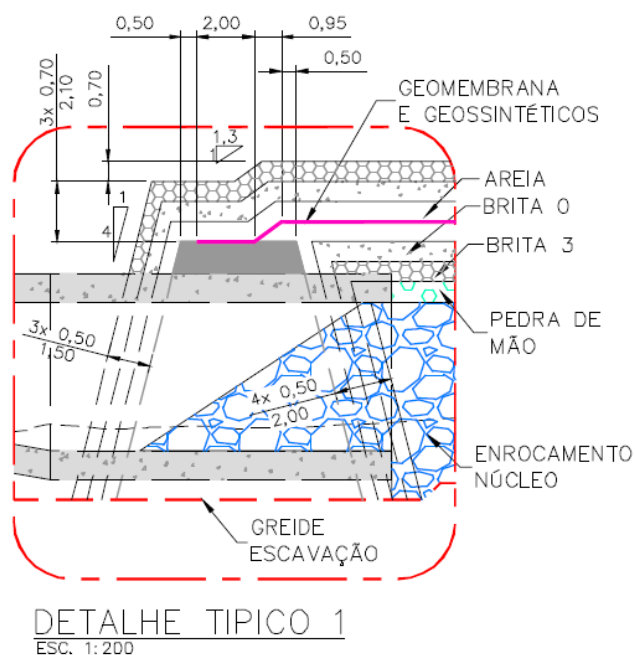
Detalhe típico do contato das estruturas de concreto com o aterro (Geoestável, 2019)
